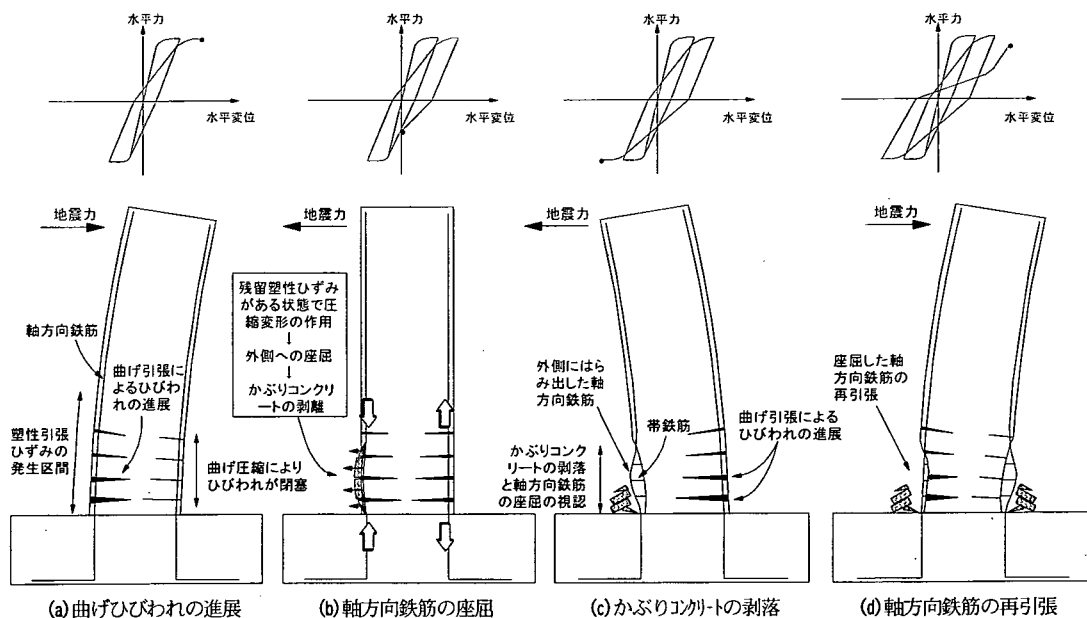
曲げ破壊型の鉄筋コンクリート橋脚の破壊メカニズム
